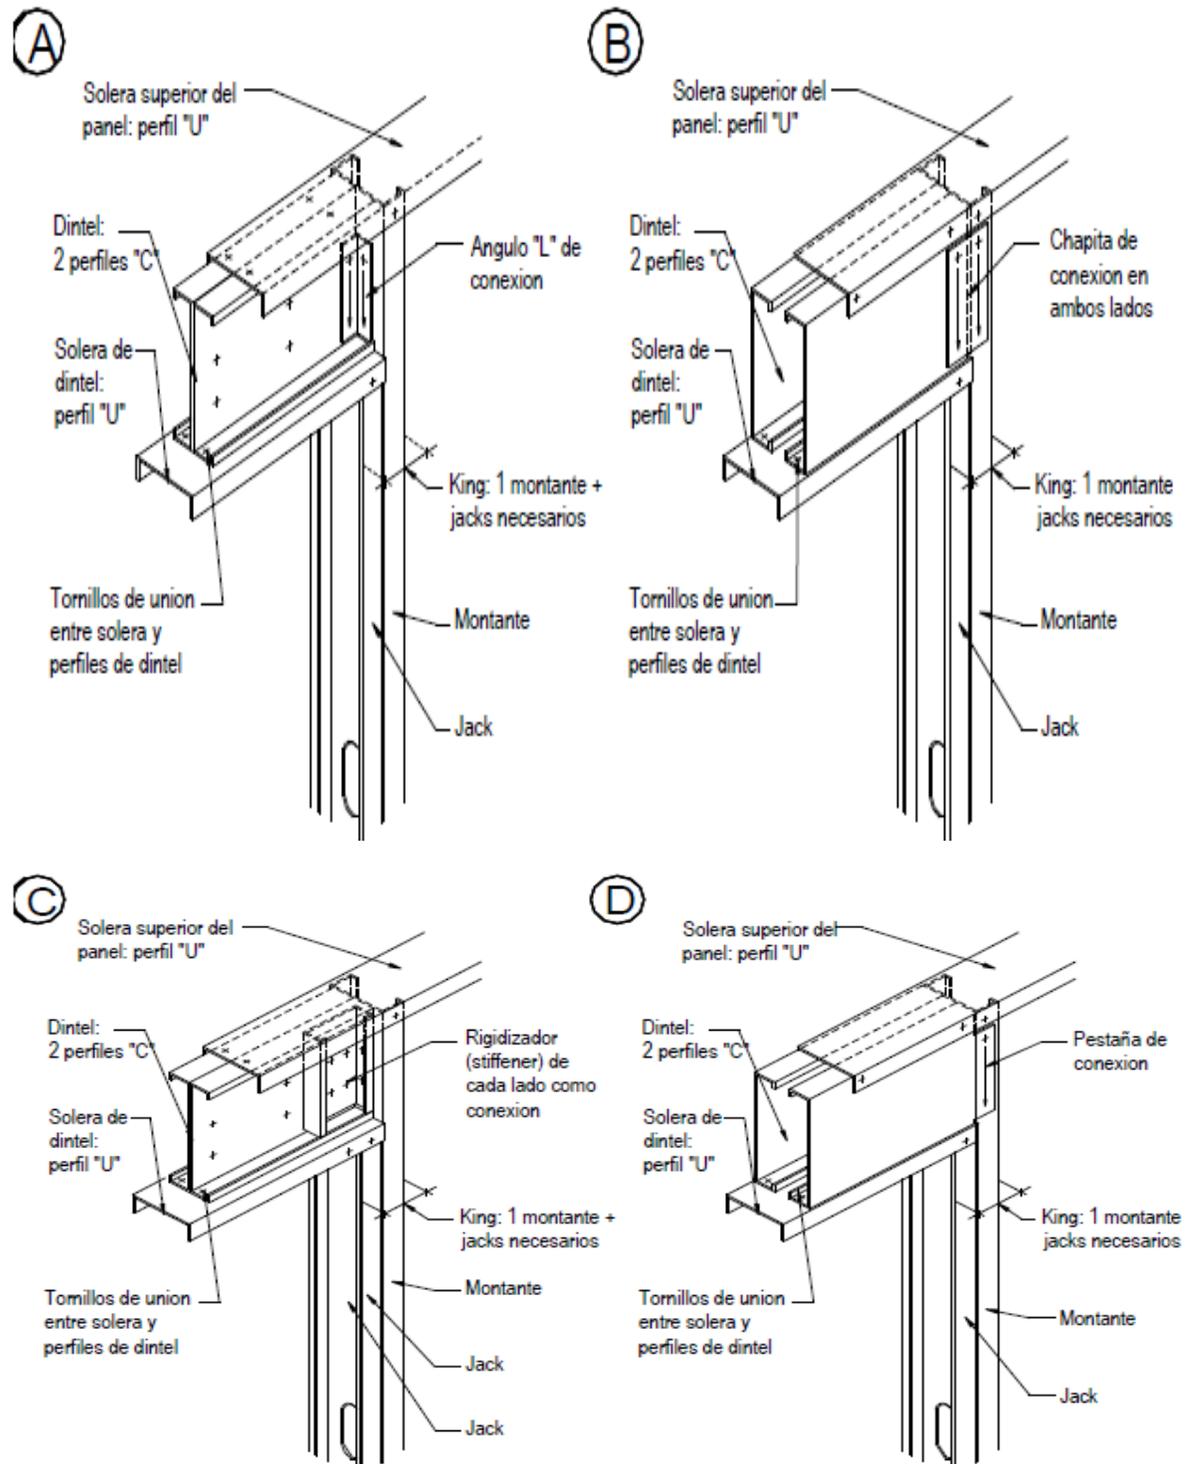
Resolución de dinteles en estructuras resueltas con Steel Framing.
